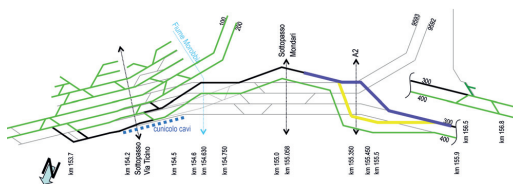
Fasi zona A2: costruzione spalle, pile lato nord ed impalcato nord in posizione provvisoria sud del nuovo cavalcavia A2 e realizzazione di tutte le infrastrutture ad esso connesse quali camere cavi, attraversamenti e bauletti cavi. Fase 1b A2: spostamento provvisorio del binario 300 LE630 sul nuovo impalcato nord.
